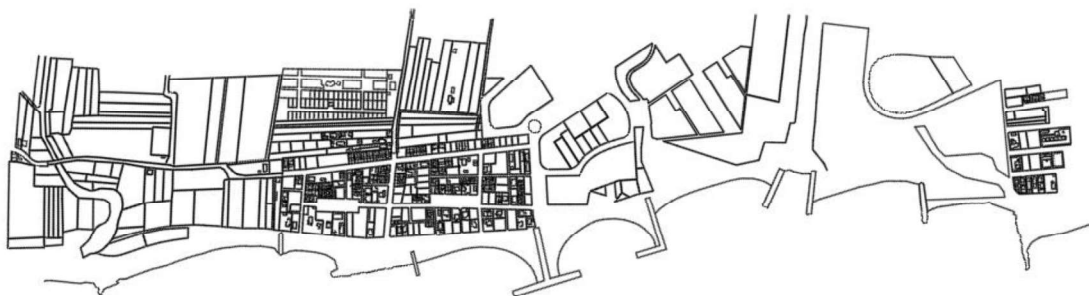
Alternativa 8: espigón en “T”. Fuente: Elaboración propia.
